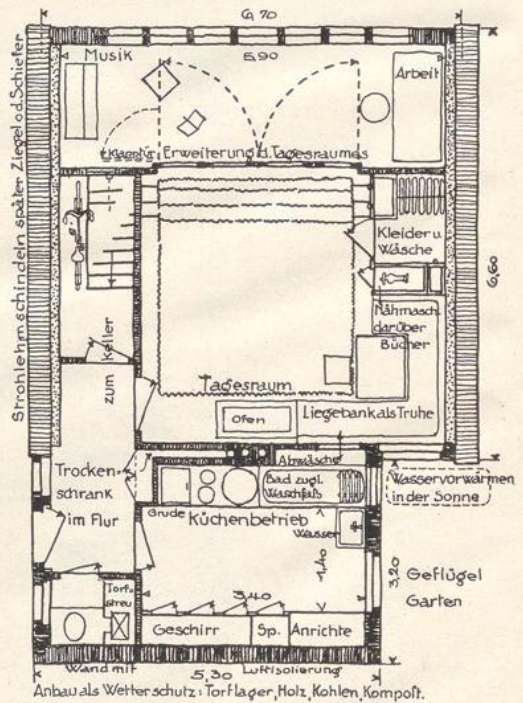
Grundriß des Erdgeschosses. (1:100)
